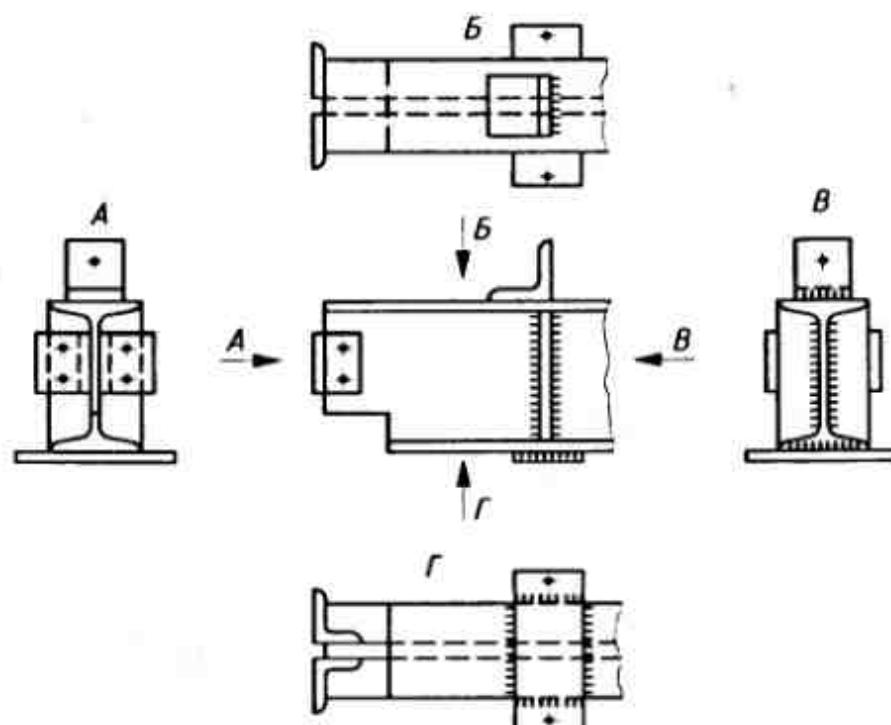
Расположение видов на чертежах металлоконструкций
